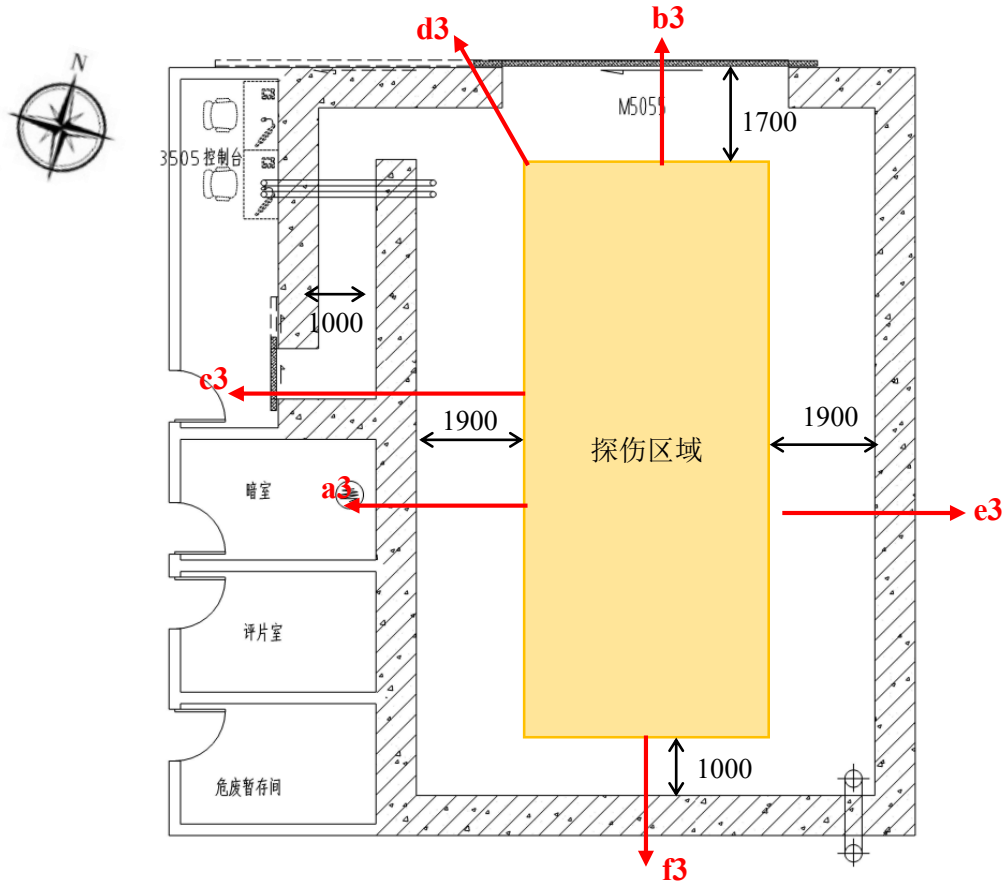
3 号探伤室辐射屏蔽计算预测点位平面图 (单位: mm)
